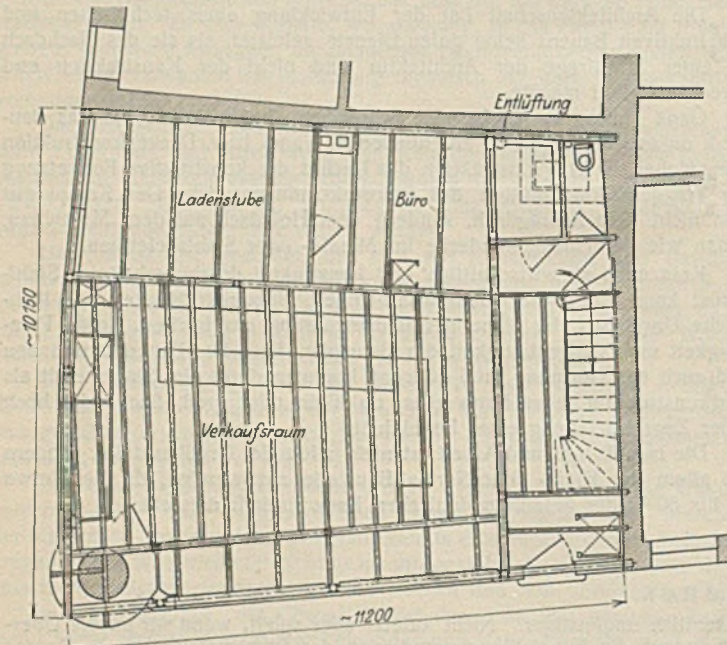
Erdgeschoßgrundriß mit Trägerlage des I. Stockwerks.
